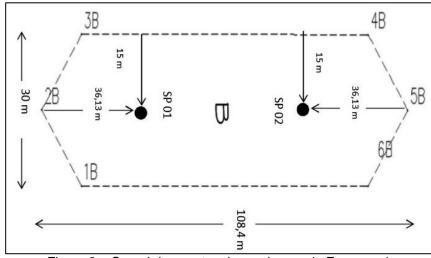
Croqui dos pontos de sondagem da Empresa 1
